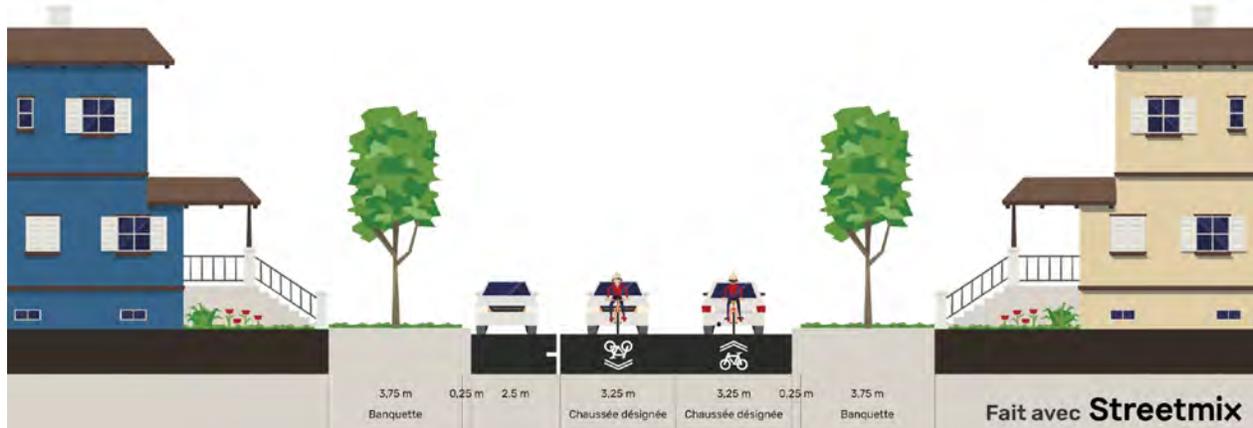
Coupe LR-02 : rue avec chaussée de 9,0 m sans trottoir
